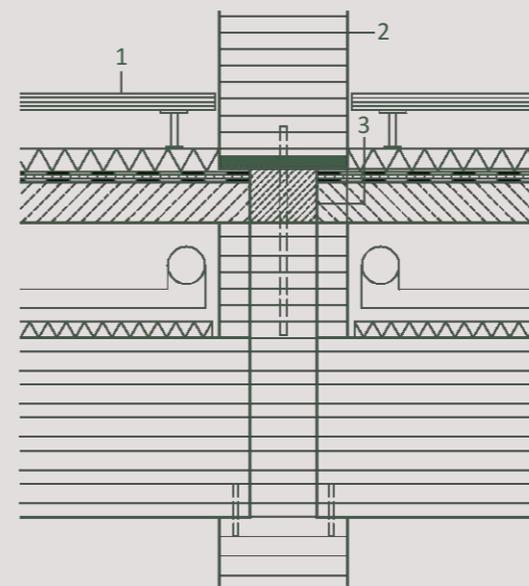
Konstruktiver Knoten | Detail M 1:20
